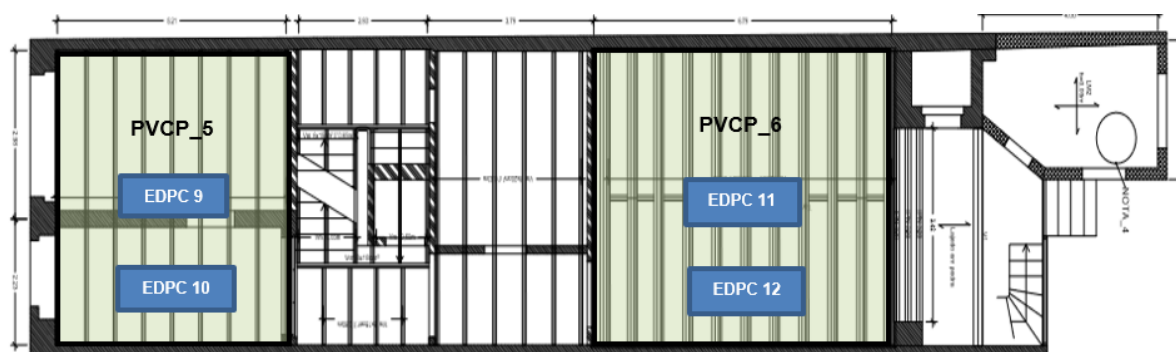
Planta do piso 1, com a identificação esquemática dos pavimentos e ensaios dinâmicos
